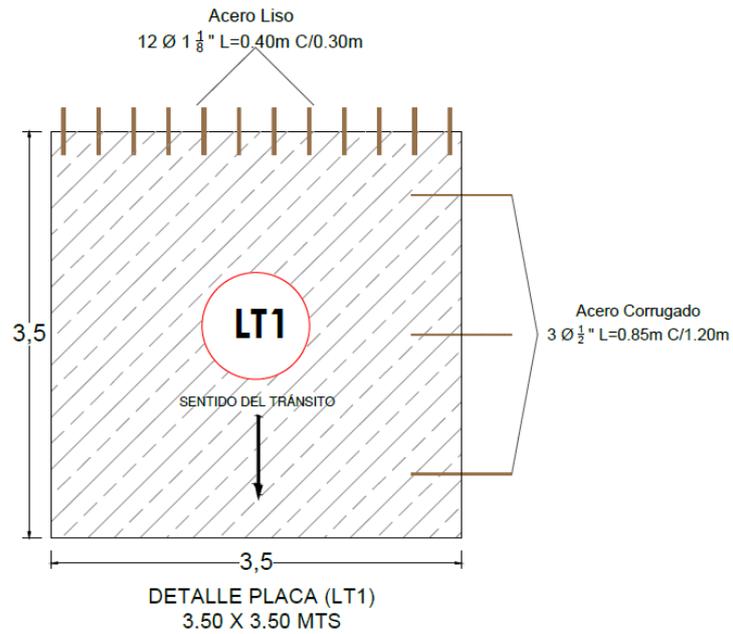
Detalle de la placa de concreto LT1. Elaboración Propia
